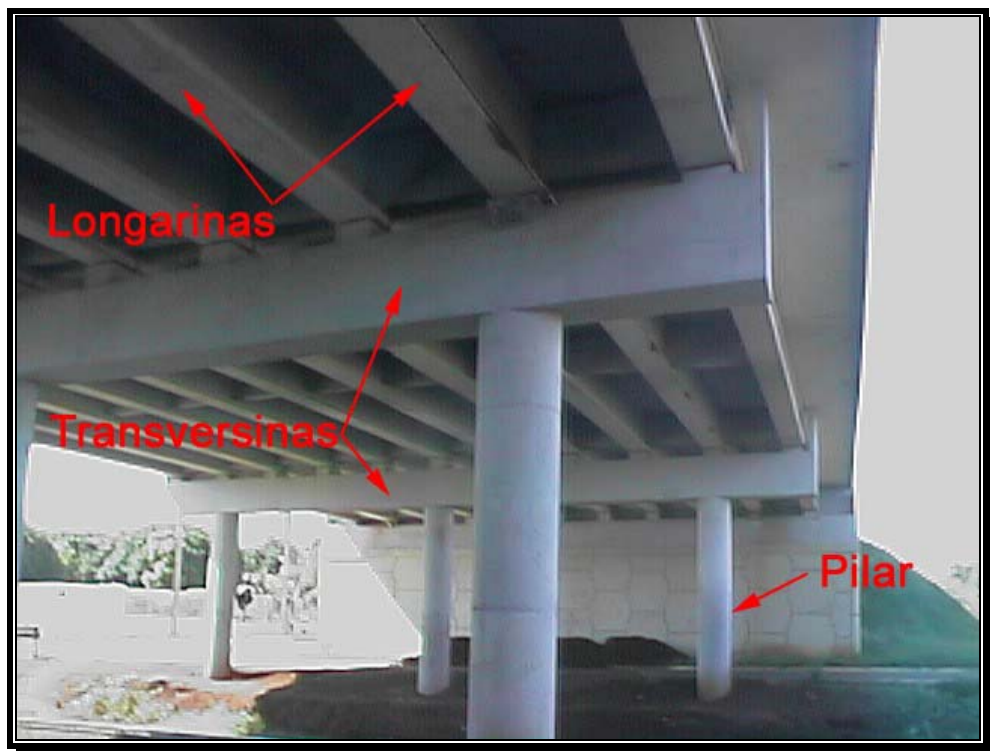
Vista Vão Central – Tabuleiro
